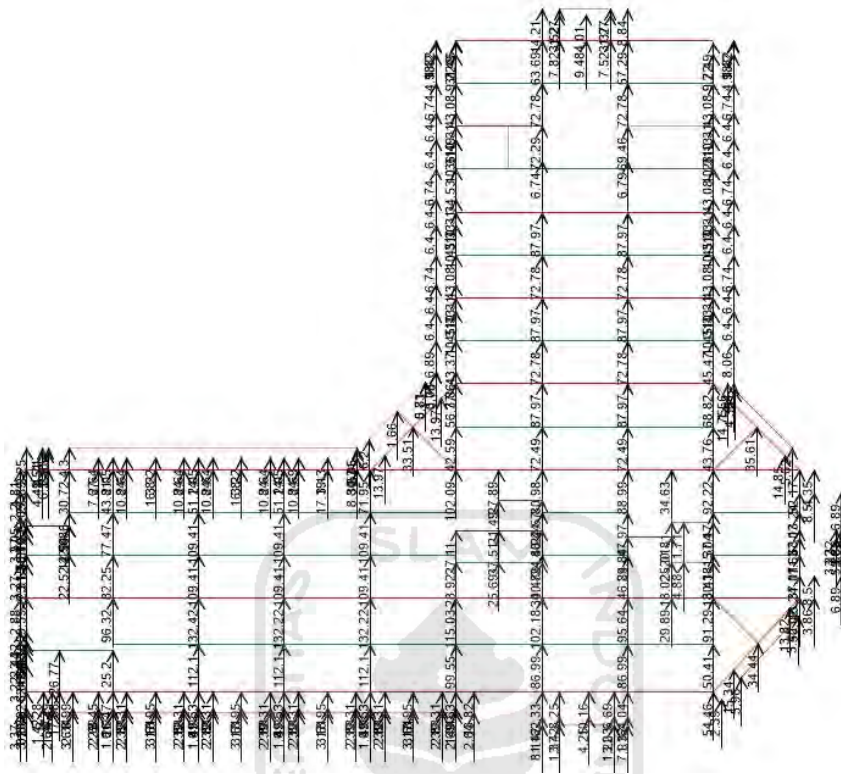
24 Gaya Joint Load Fpx Arah X pada Lantai 6
